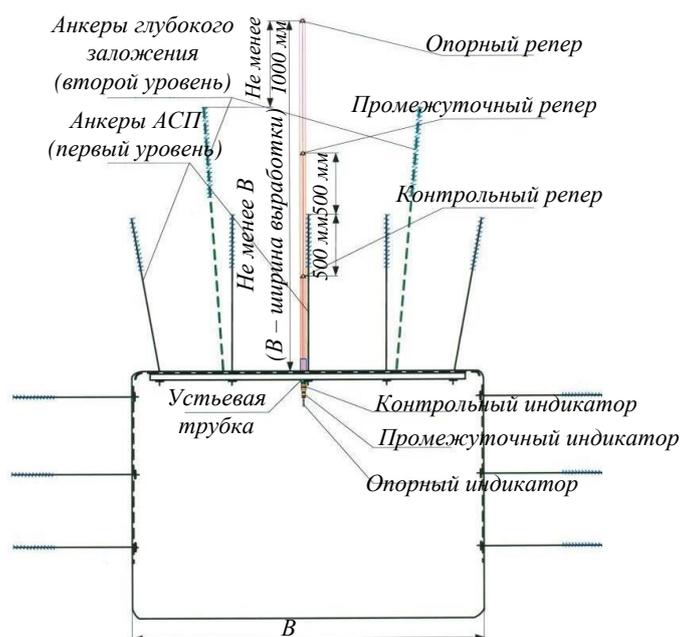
Схема наблюдательной станции для измерения смещений пород кровли выработки
